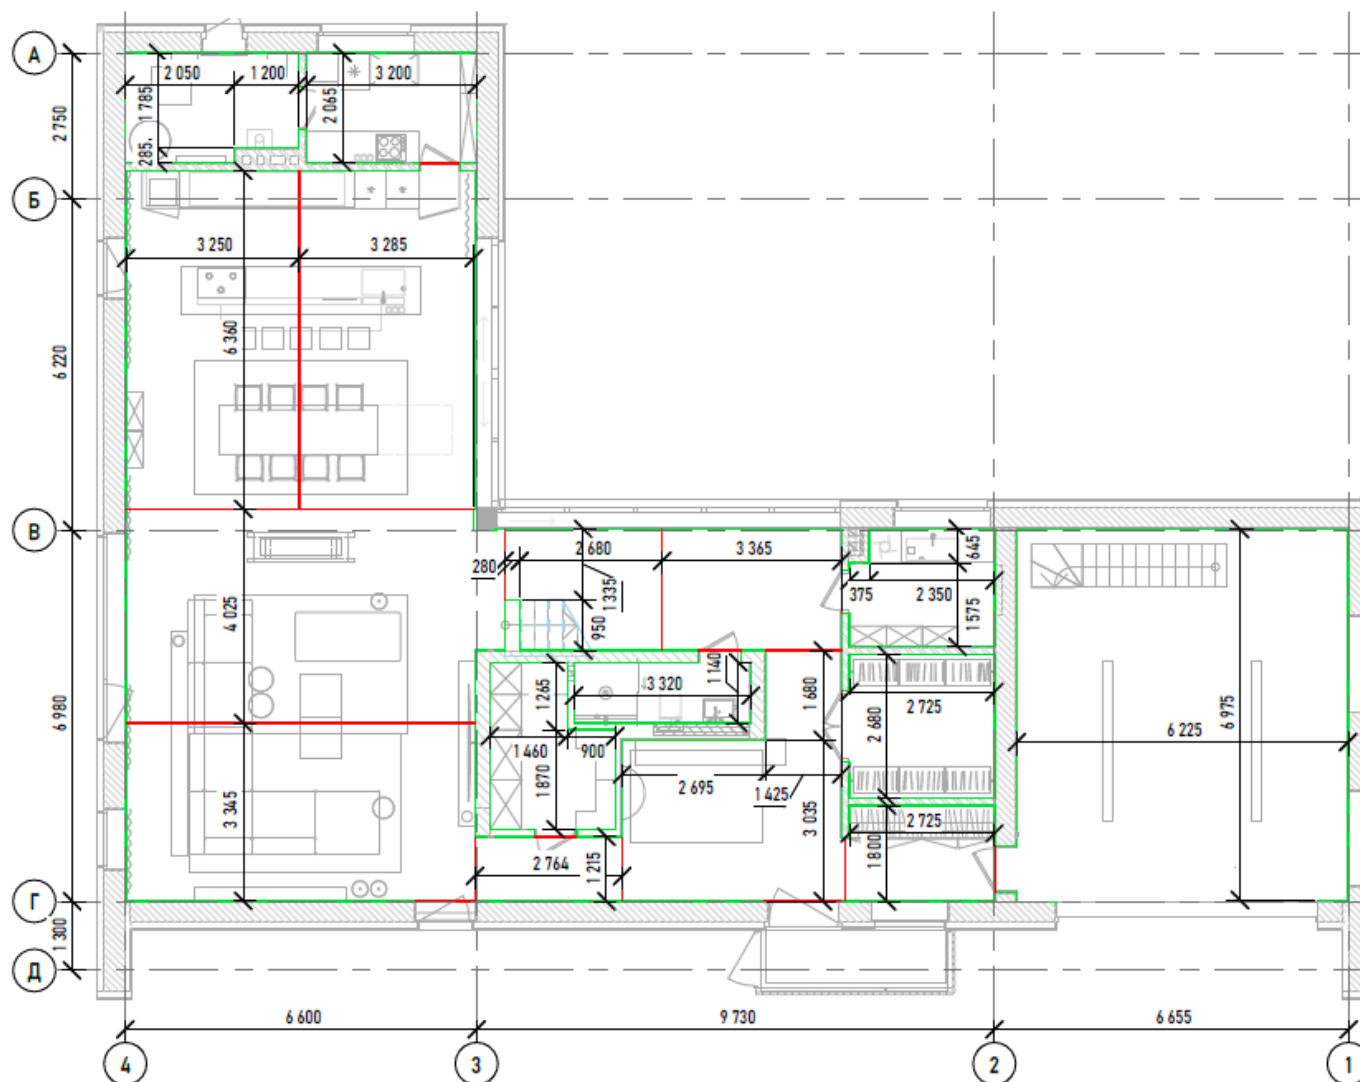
Схема прокладання демпферних стрічок та деформаційних швів. План 1-го поверху
